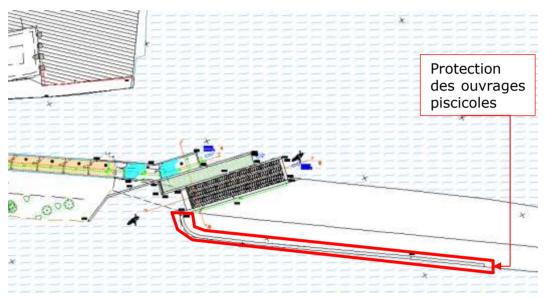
Vue en plan de la protection des ouvrages piscicoles
